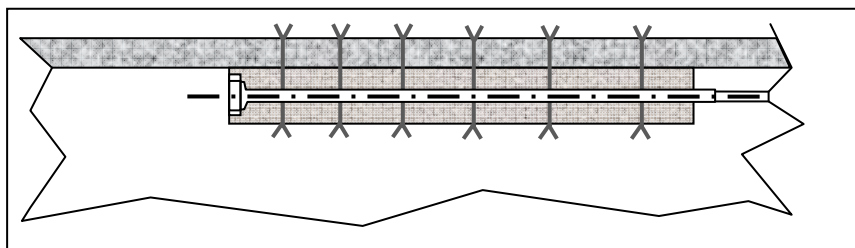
Bossage cloué sur une âme (coupe horizontale)
